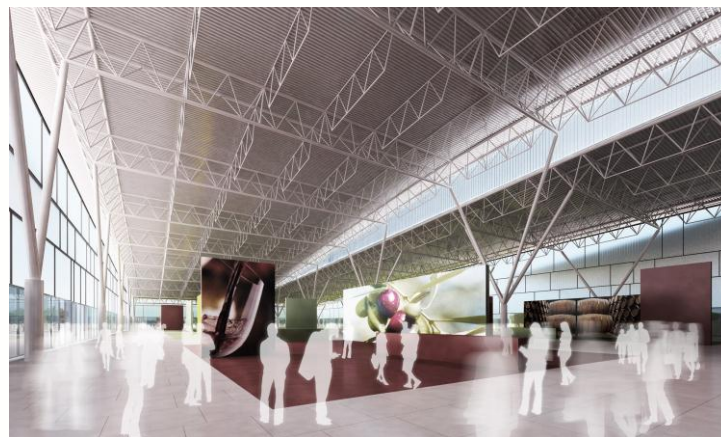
Vista interior de la nave. Apreciación de la tipología estructural.
